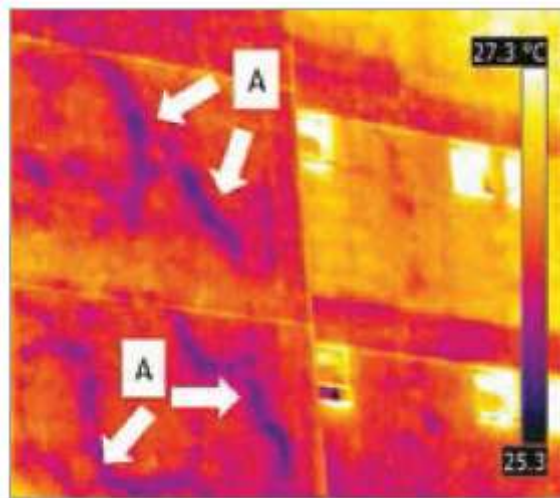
Identificação e mapeamento de fissuras em fachadas com revestimento em argamassa e pintura (Bauer e Pavón, 2015).
